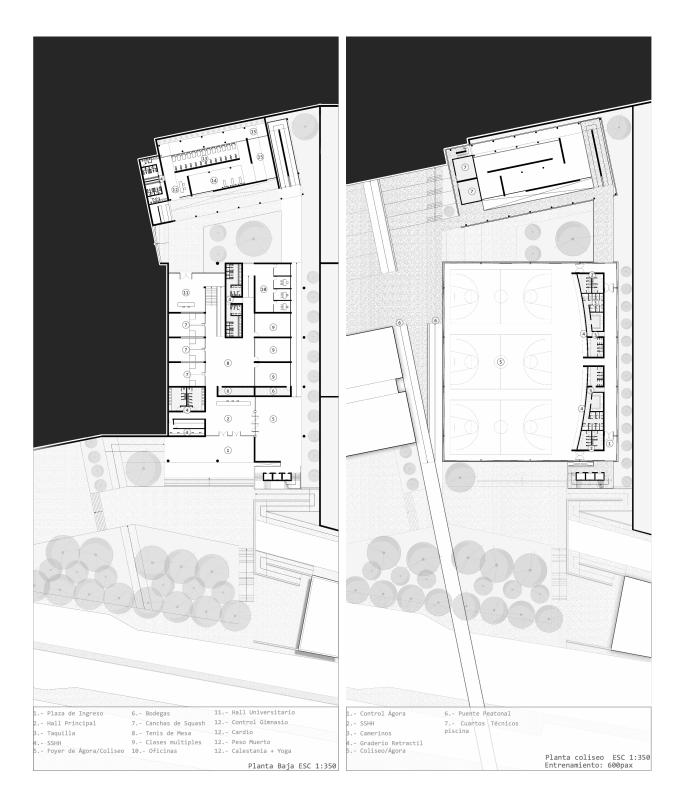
Planta baja(+2.00) y planta coliseo(+8.00)
